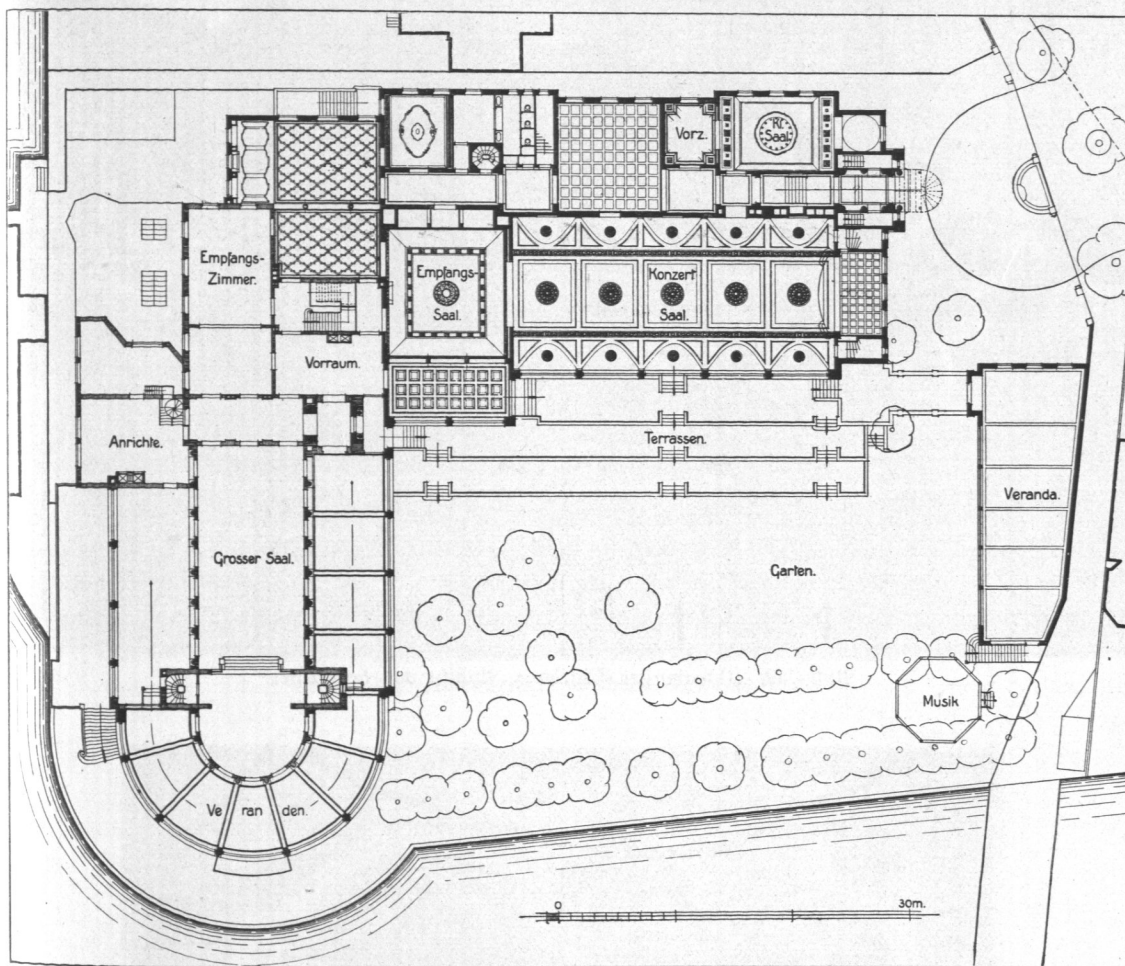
Uhlenhorster Fährhaus, Grundriß.
